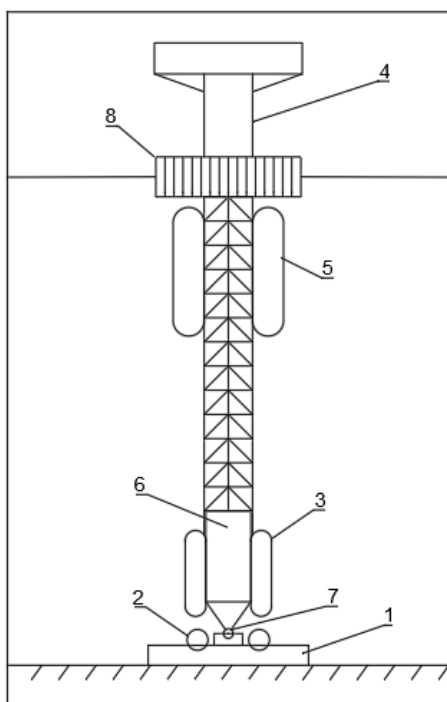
Основные элементы МП: 1-основание; 2 – поплавок основания; 3 – вспомогательные поплавок опоры; 4 – надводная платформа; 5 – главный поплавок; 6 – балласт опоры; 7 – карданный шарнир; 8 – кранцы.
